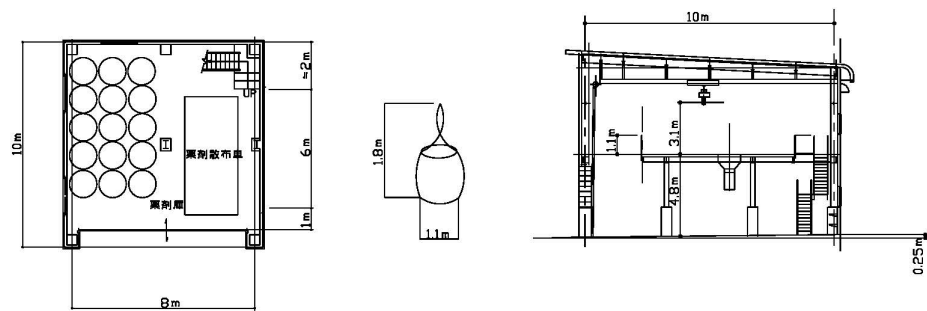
《参考例》単独整備の薬剂庫 平面図及び断面図
